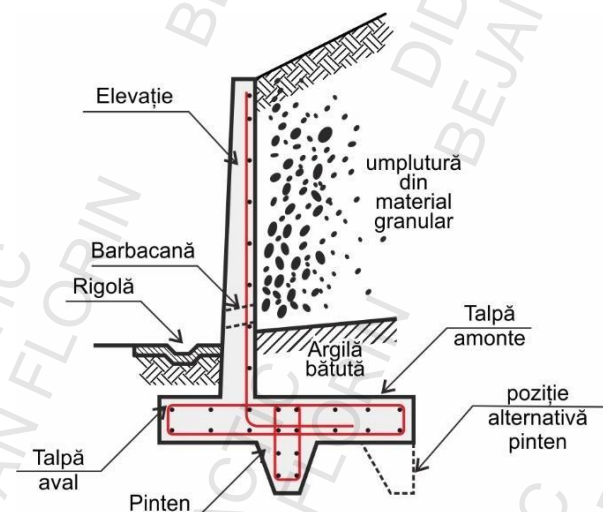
Elementele componente ale unui zid de sprijin din beton armat
